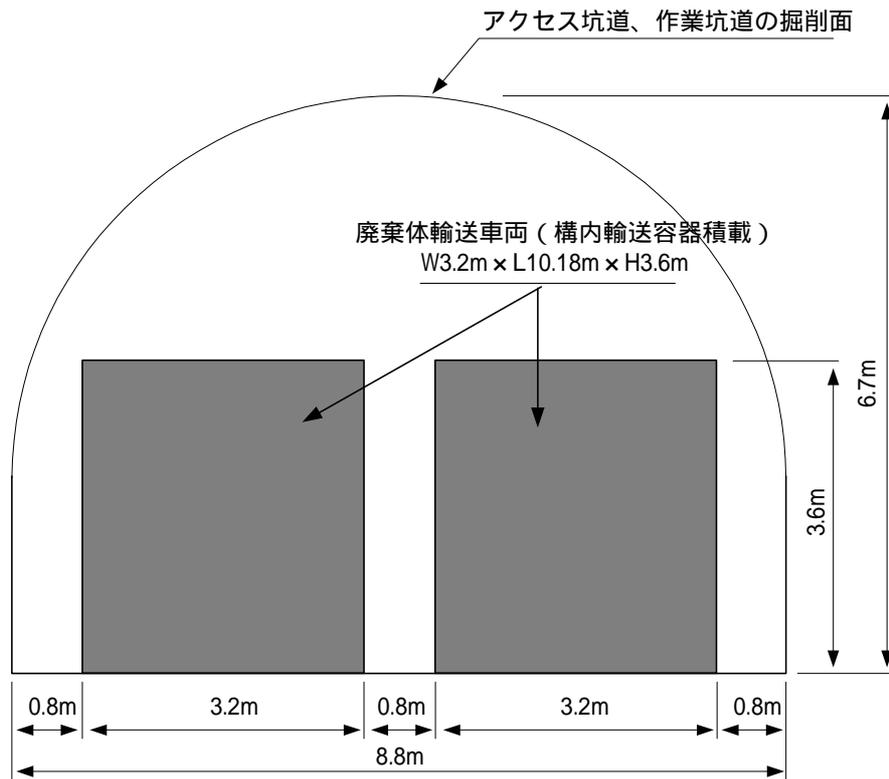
アクセス坑道、作業坑道の垂直断面図
